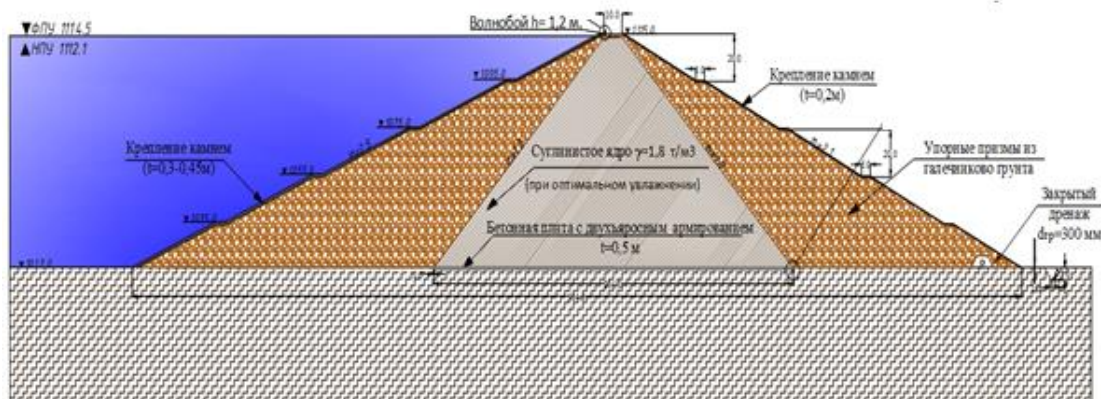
Расчетная схема проектируемой Кизилсайской грунтовой плотины: 1—центральное ядро; 2 —переходные зоны; 3 и 4— верхняя и нижняя упорные призмы; 5,6 – верхние и нижние откосы
